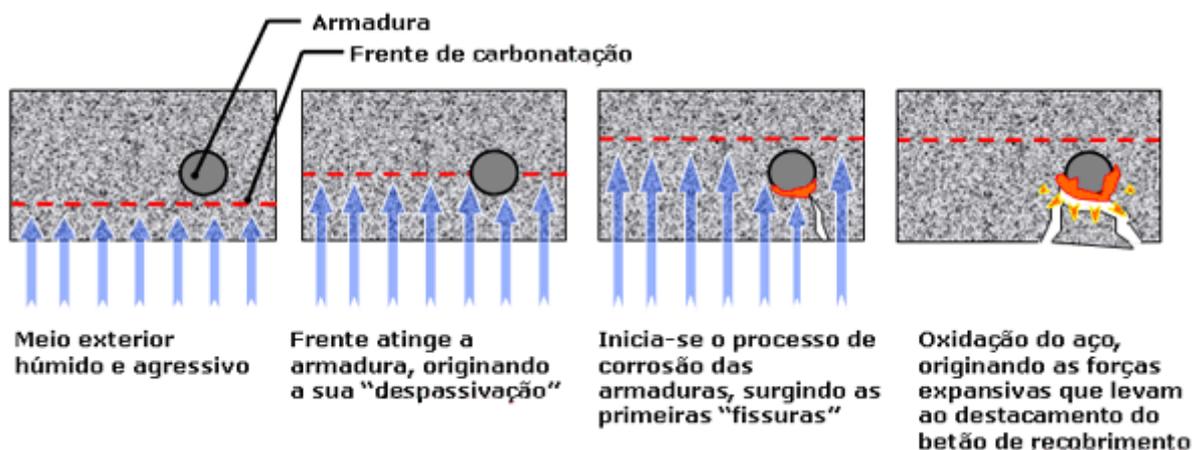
Processo de corrosão das armaduras em elementos de betão armado e consecutivo destacamento (PATORREB, 2016)
